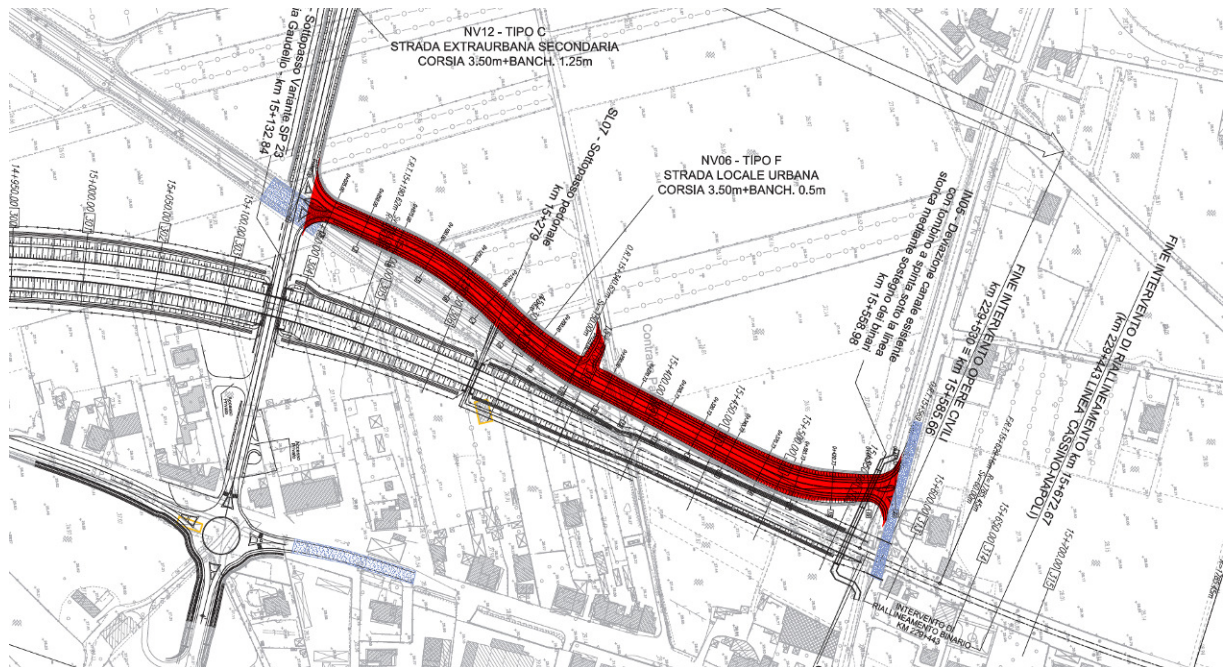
Contesto di analisi G – Progetto Esecutivo - Planimetria (in rosso la nuova strada)
